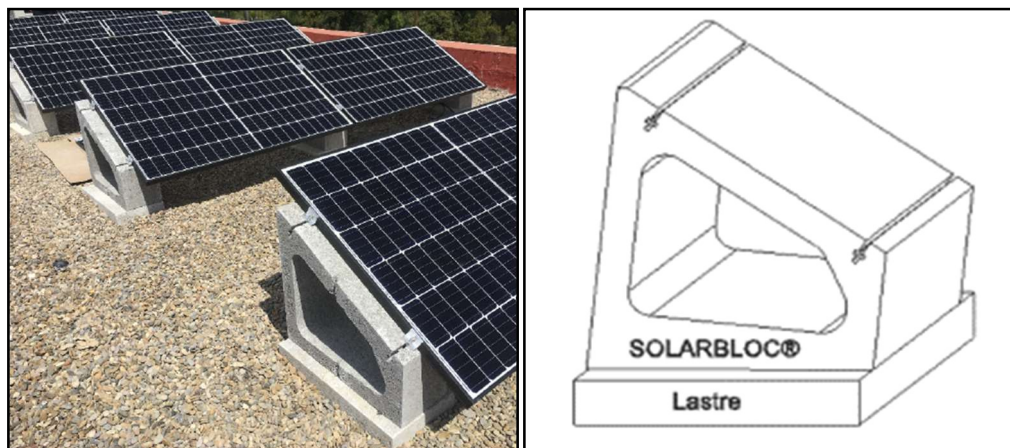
Modelo tipo de instalación, con lastre. Fuente: Solarbloc.
